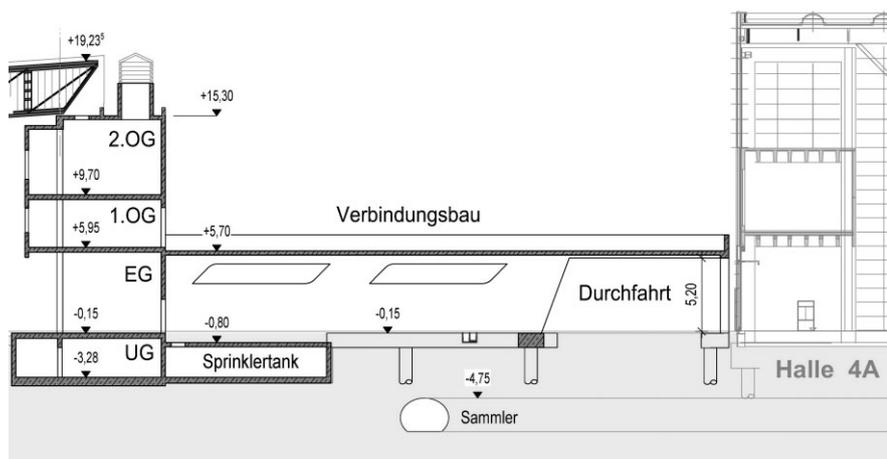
Längsschnitt Verbindungsbau inklusive Gründung und Sammler
